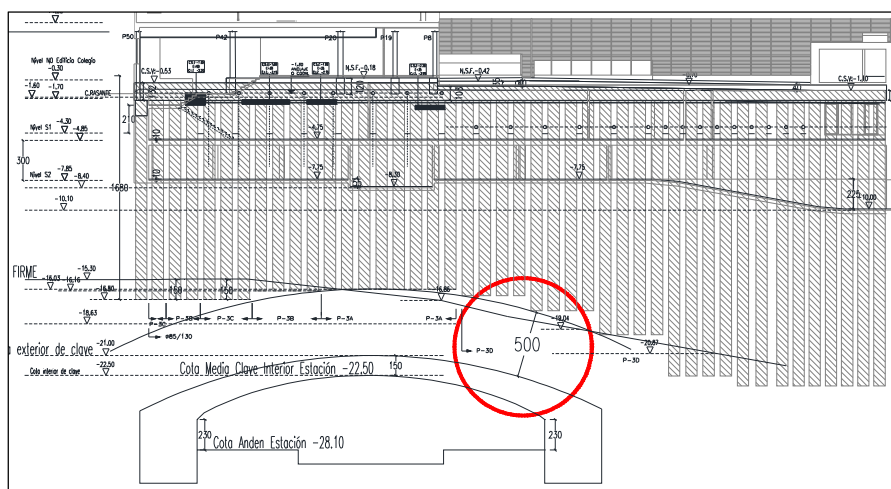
Sección cimentación y bóveda de metro, limitación 5m METRO
